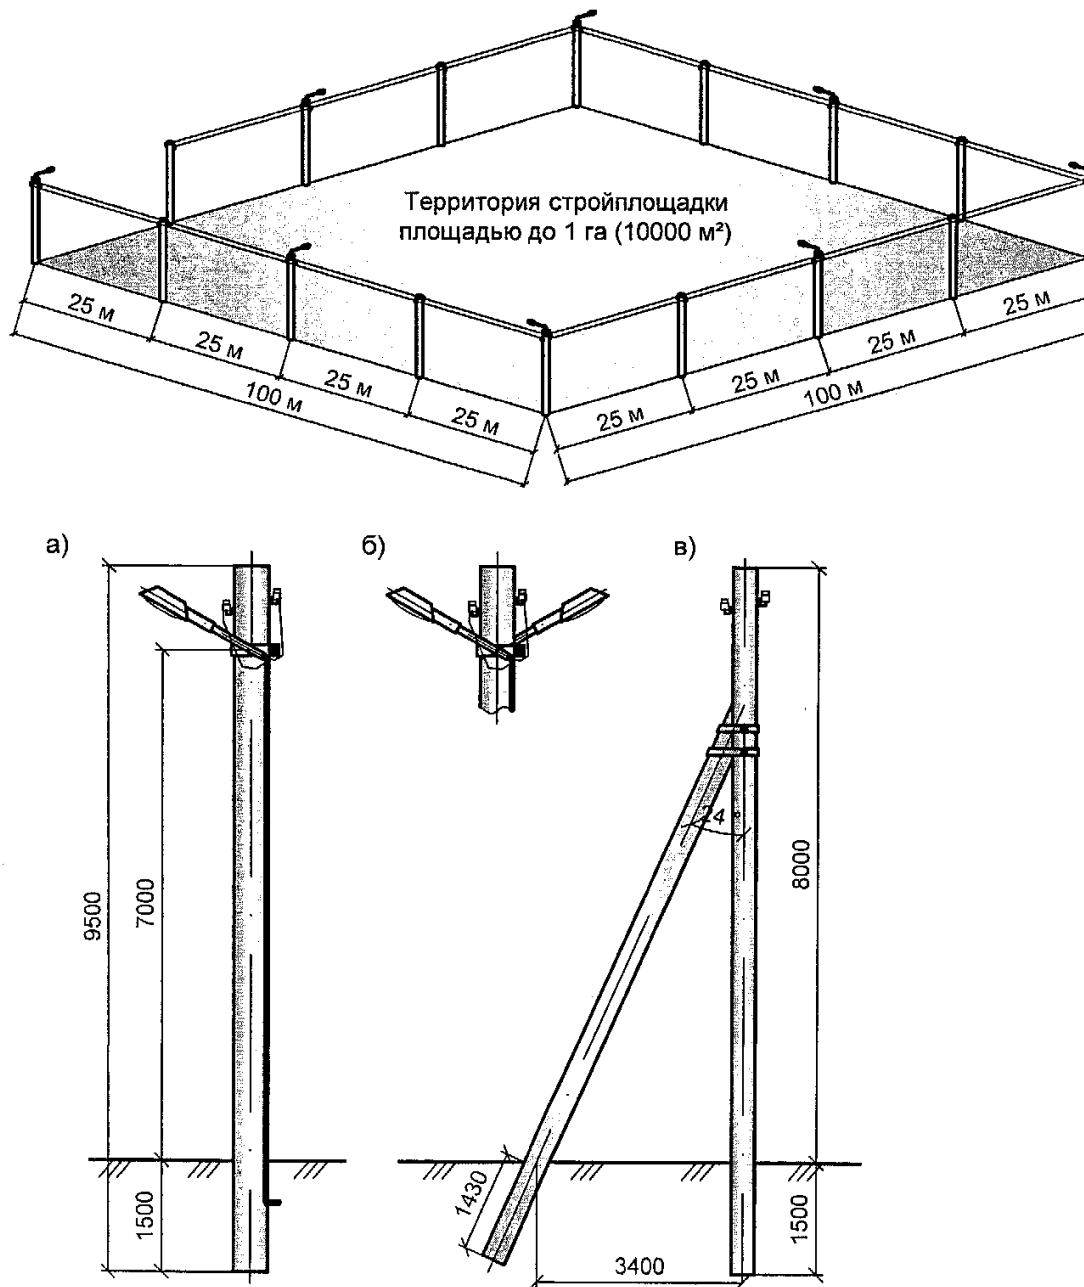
Схема освещения строительной площадки при помощи железобетонных опор:
